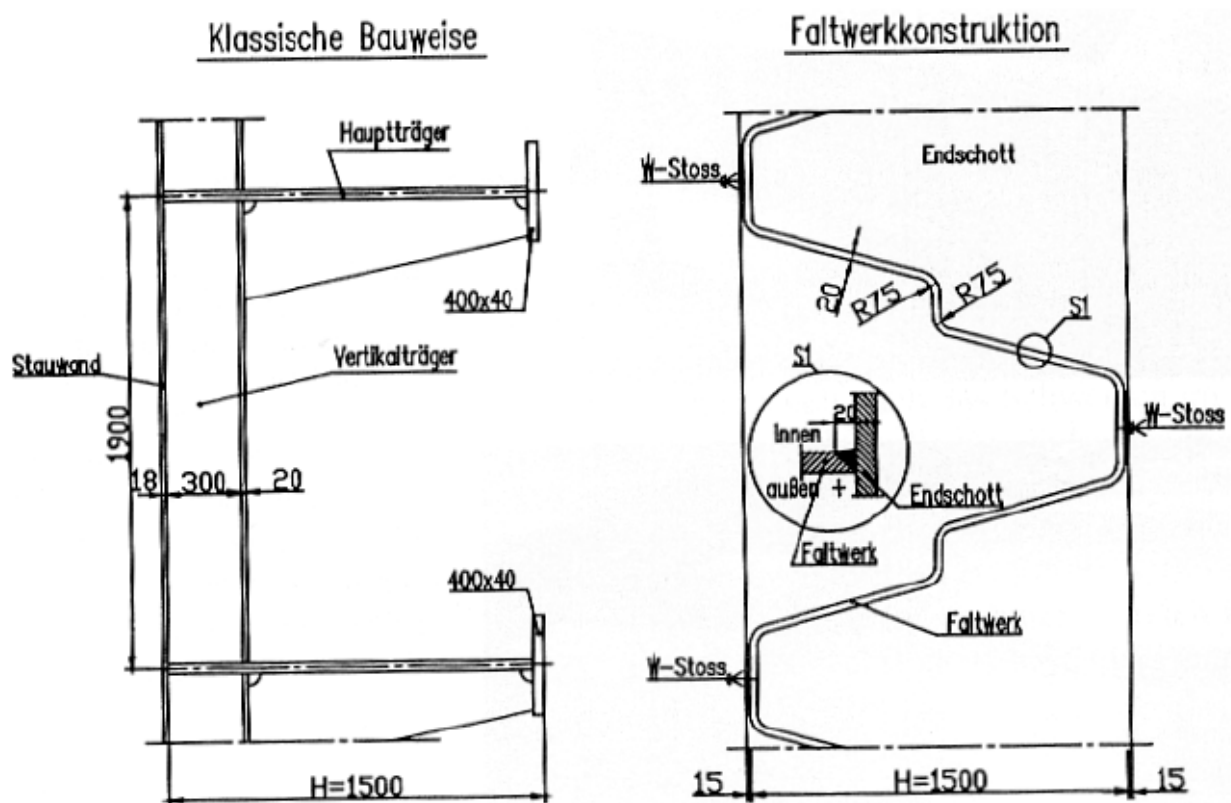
Riegelkonstruktion (klassische Bauweise) und Falwerkkonstruktion [2]
